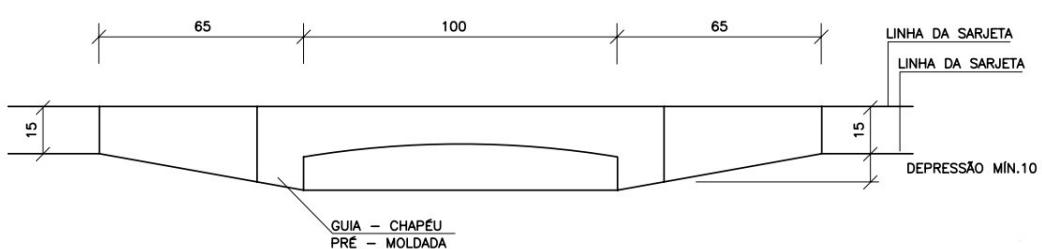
Vista frontal da boca de lobo do tipo guia chapéu com depressão (medidas em cm)
